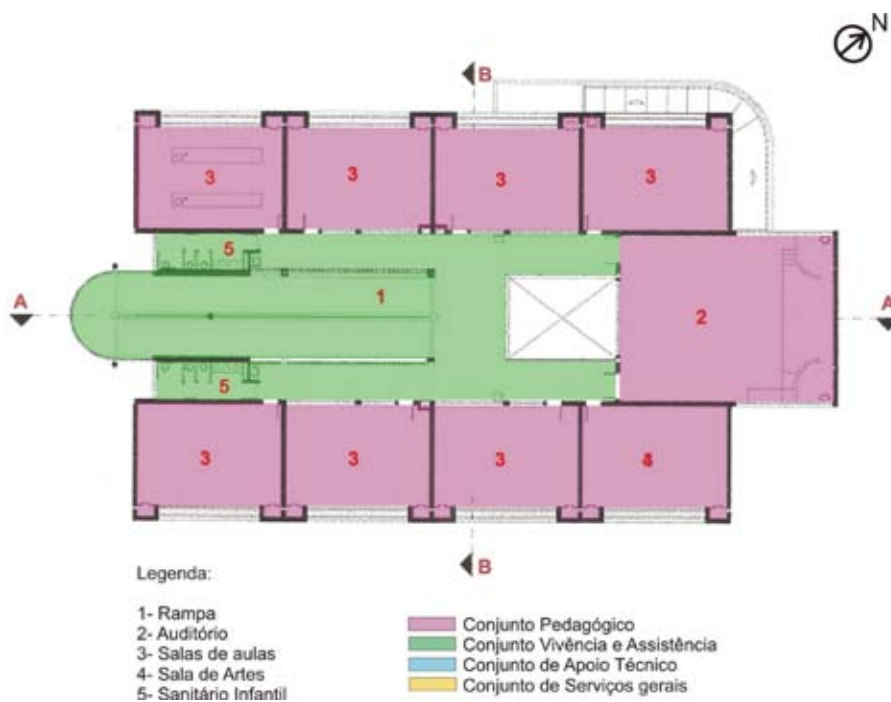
1º Pavimento da E. M. Tia Ciata
